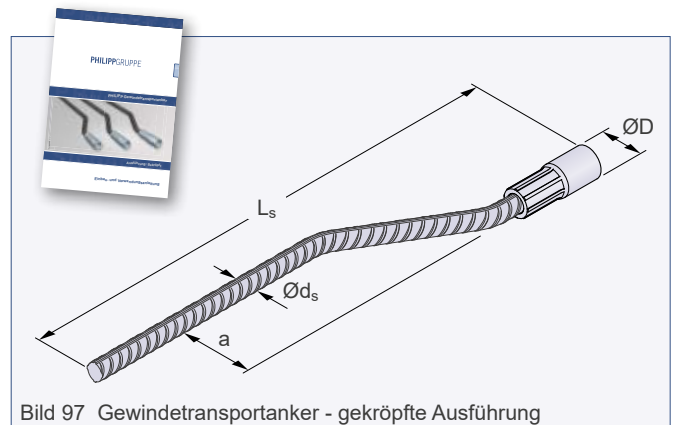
Gewindetransportanker - gekröpfte Ausführung
